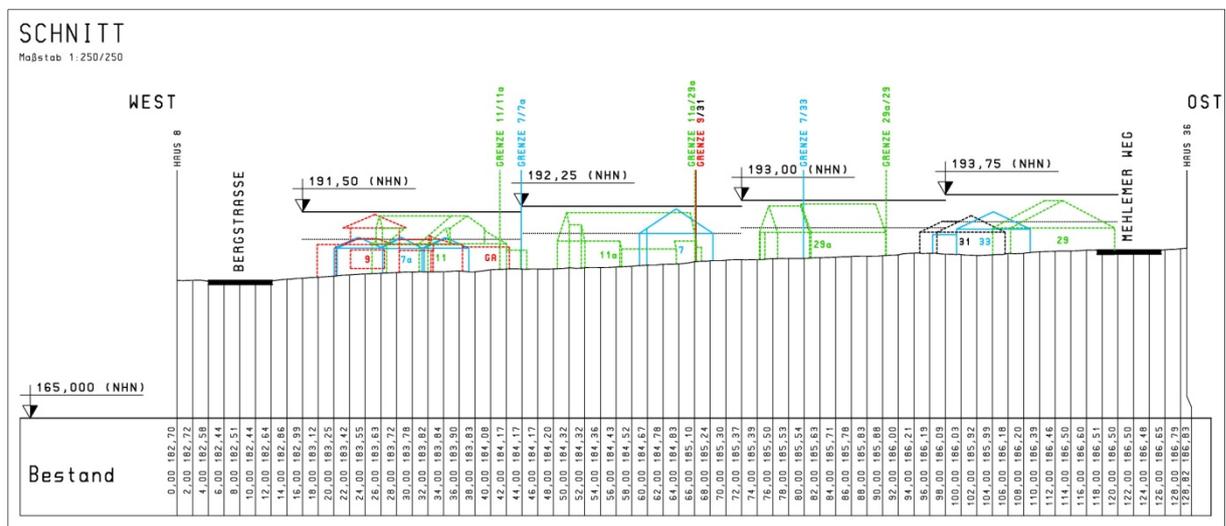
Schnitt Bergstraße – Mehlemer Weg
